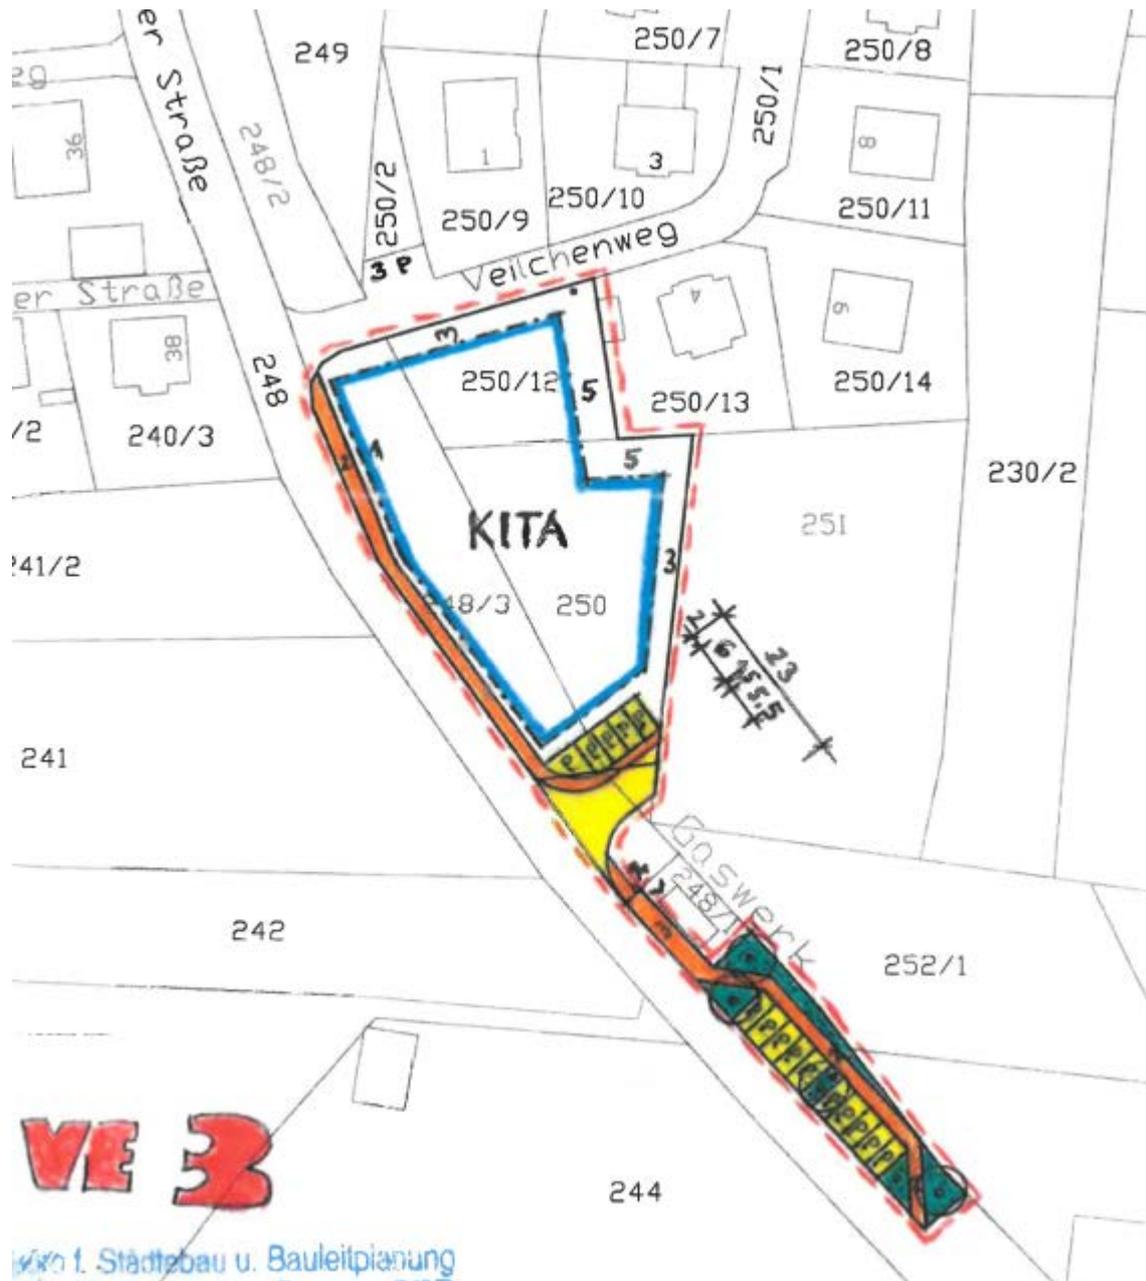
Geplante Bebauung für eine Kindertagesstätte in Dormitz
